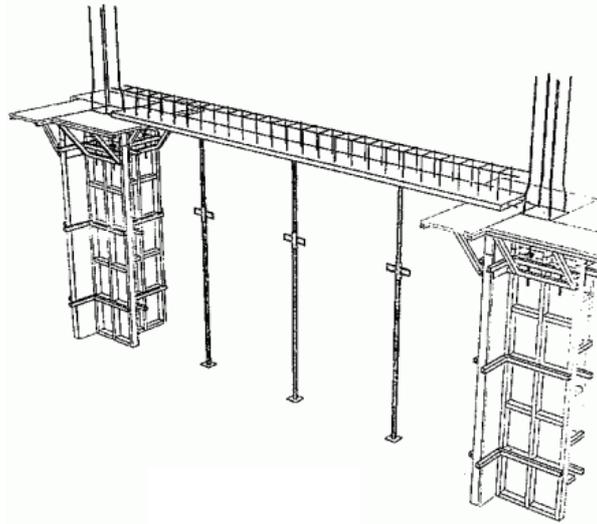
Tipos de armado de vigas. (FELIX, 2013)
